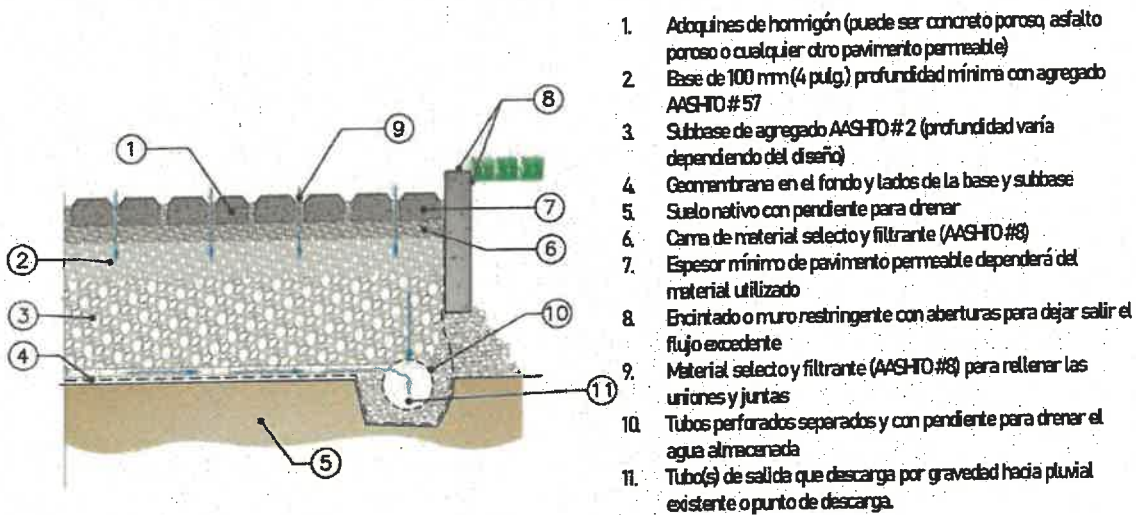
Sistema de pavimento permeable diseñado sin infiltración provisto de una geomembrana y tubería perforada
